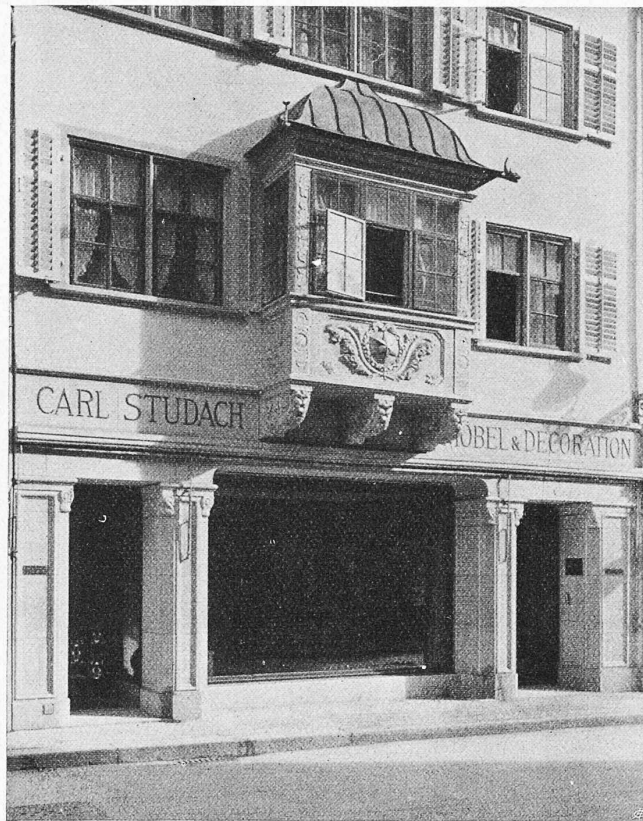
Ladenumbau an der Speisergasse in St. Gallen.
